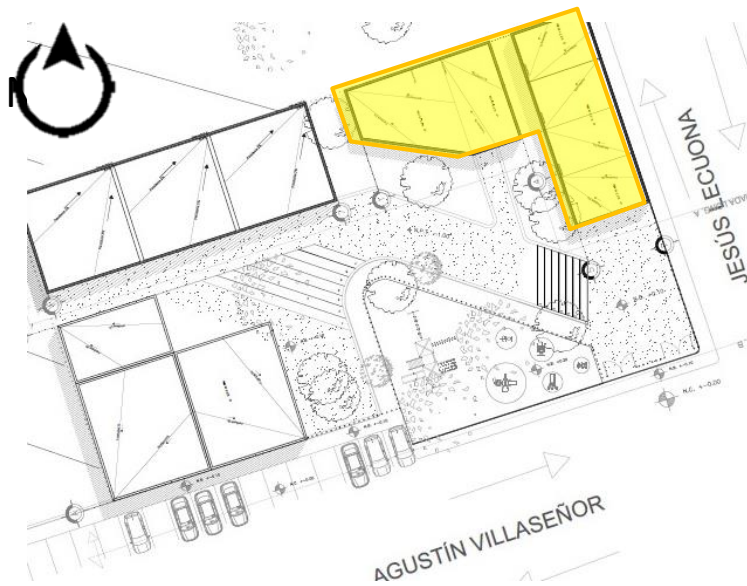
Plano de conjunto. Fuente: Elaboración propia. 2020
